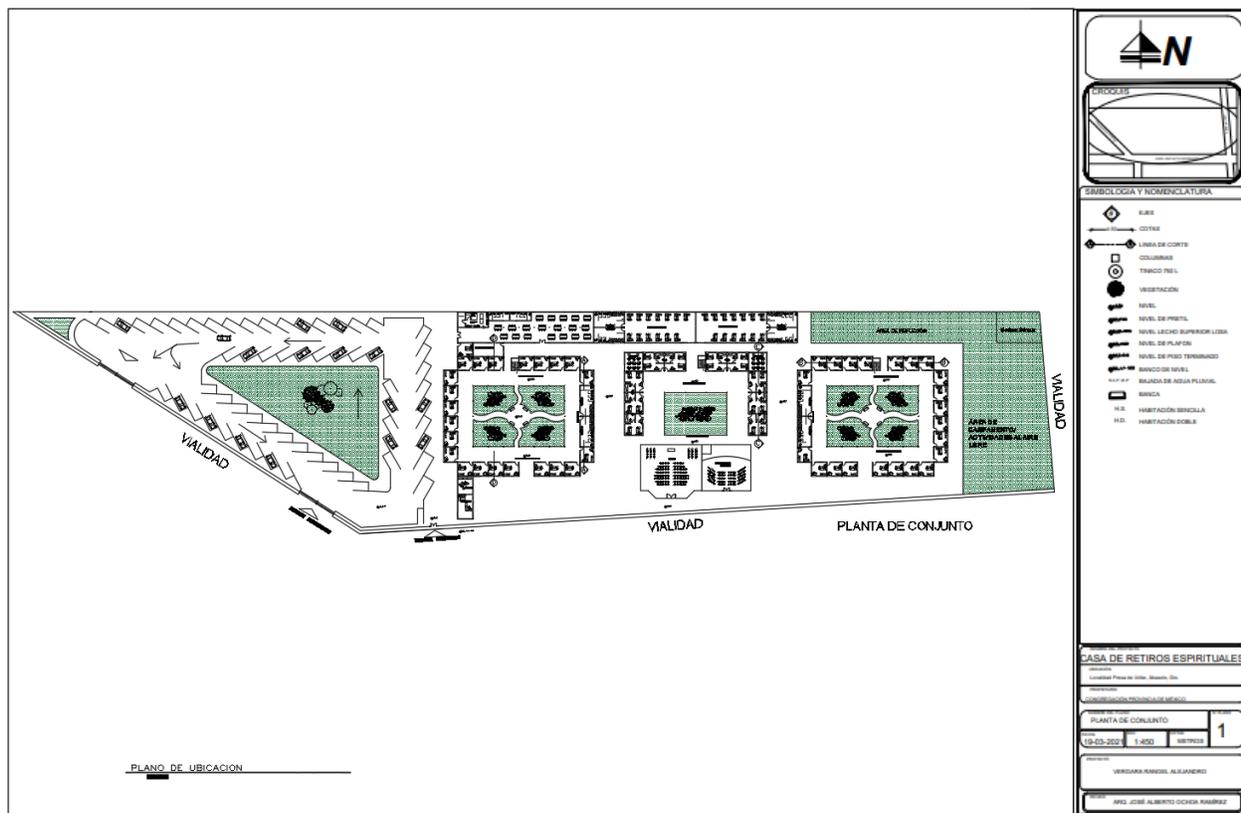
Anteproyecto planta de conjunto. (Fuente propia, 2021)
